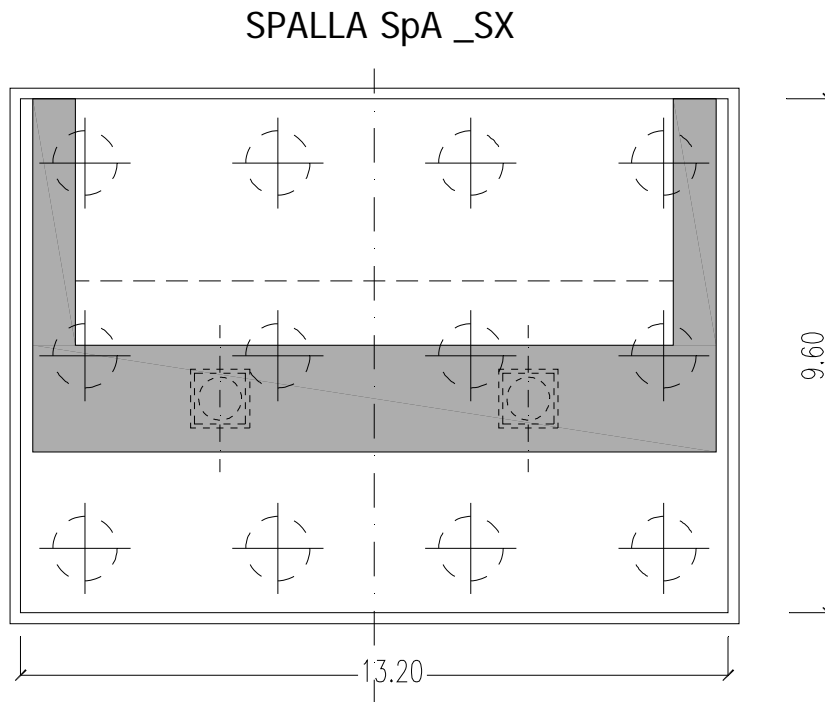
Pianta fondazione spalla A carreggiata sinistra
